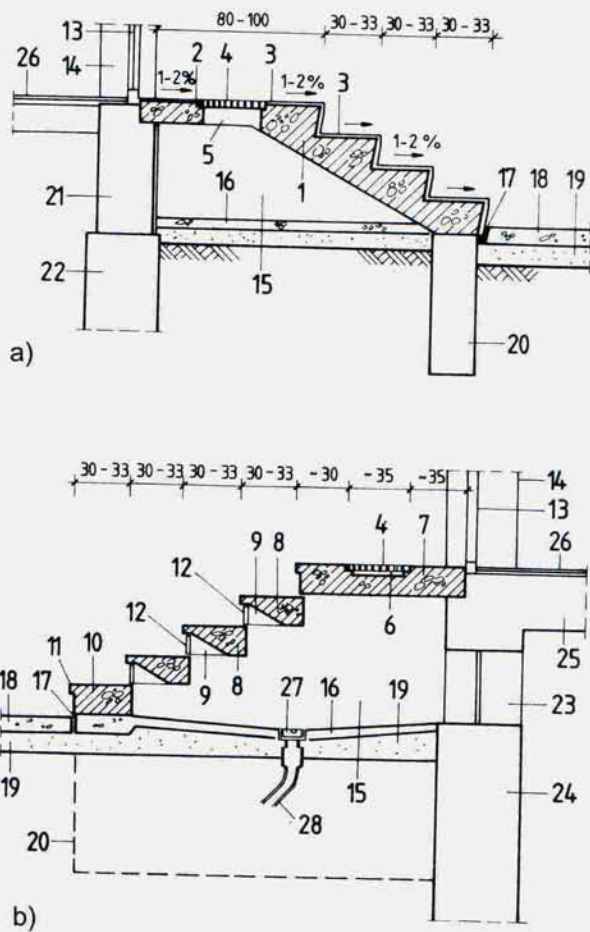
Наружные крылечные лестницы с фундаментом
